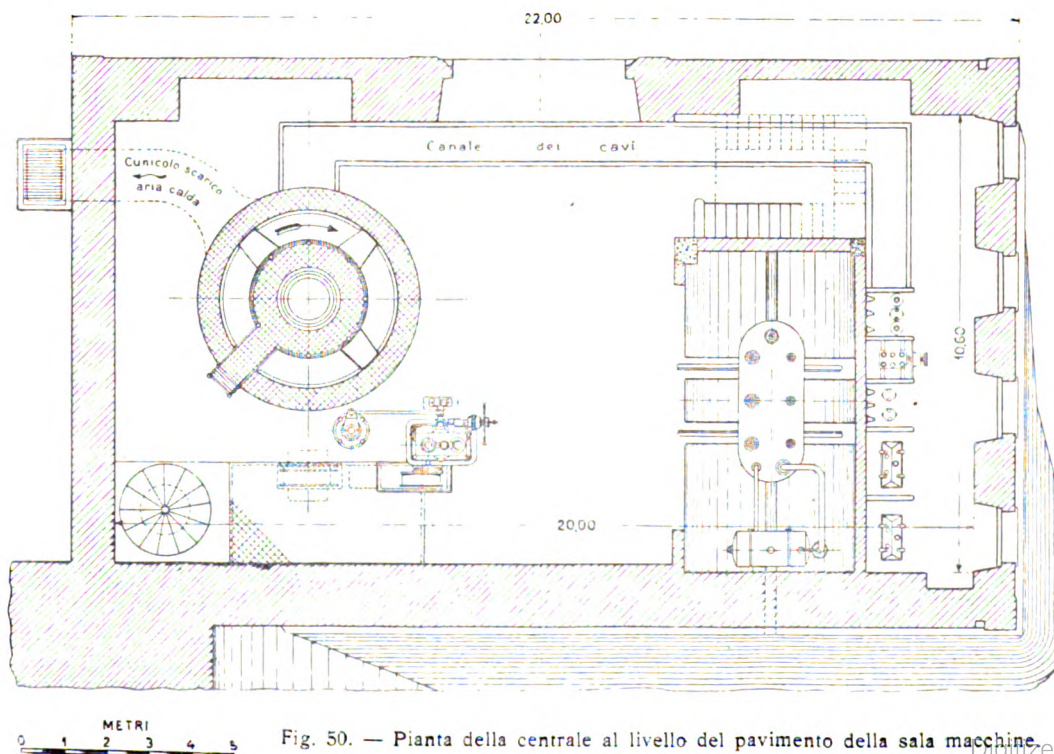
Pianta della centrale al livello del pavimento della sala macchine.
